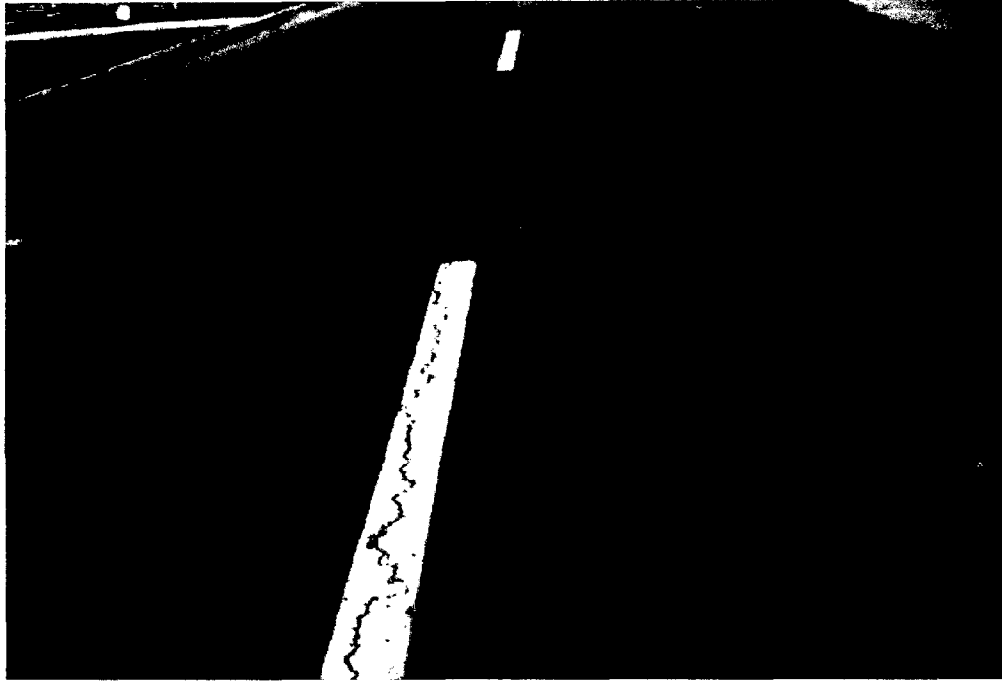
Nivel bajo de fisuramiento longitudinal.
